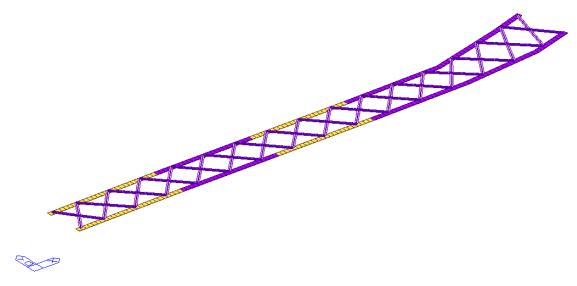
Vista del sistema di controventamento inferiore – Rampa C
